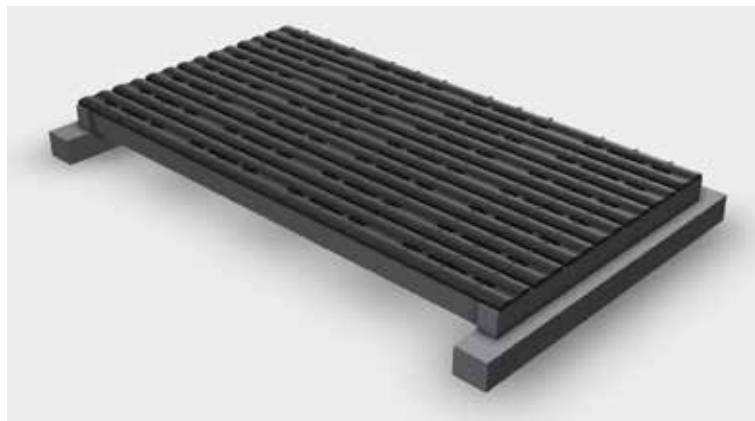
Gummiauflage mit konvexer Wölbung zum Schlitz; Aufsicht (© KTBL)
